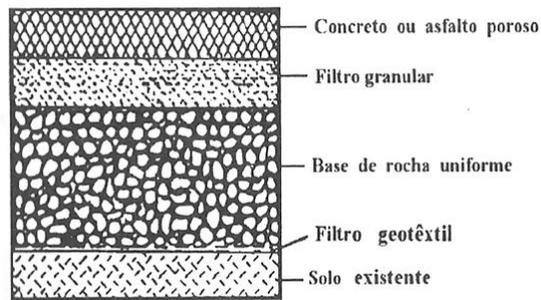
Pavimento poroso (Urbonas e Stahre, 1993)
